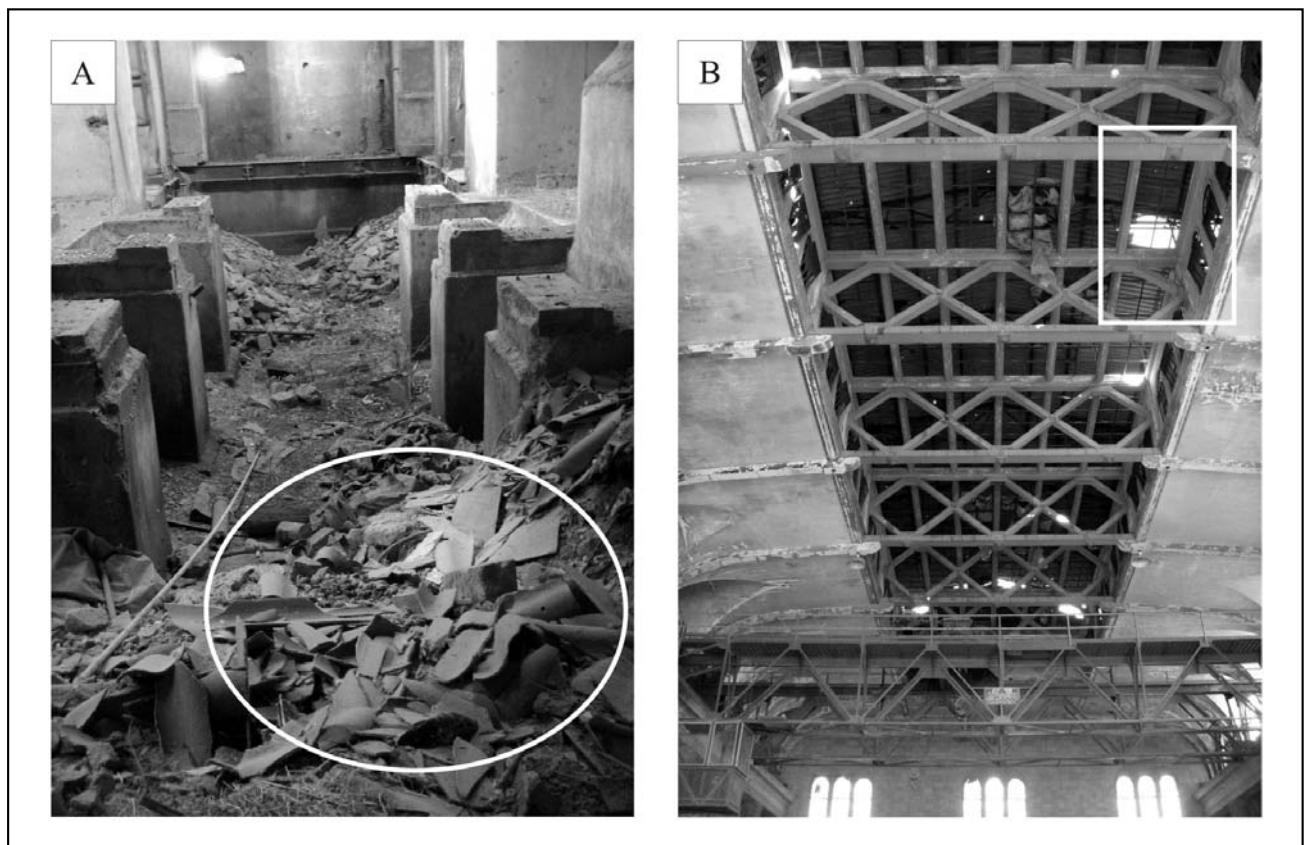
A. Planta baja. Escombros y fragmentos de losas en el suelo. La zona marcada indica el material muestreado. B. En el sector recuadrado se observa la posición original que ocupaban las losas.
